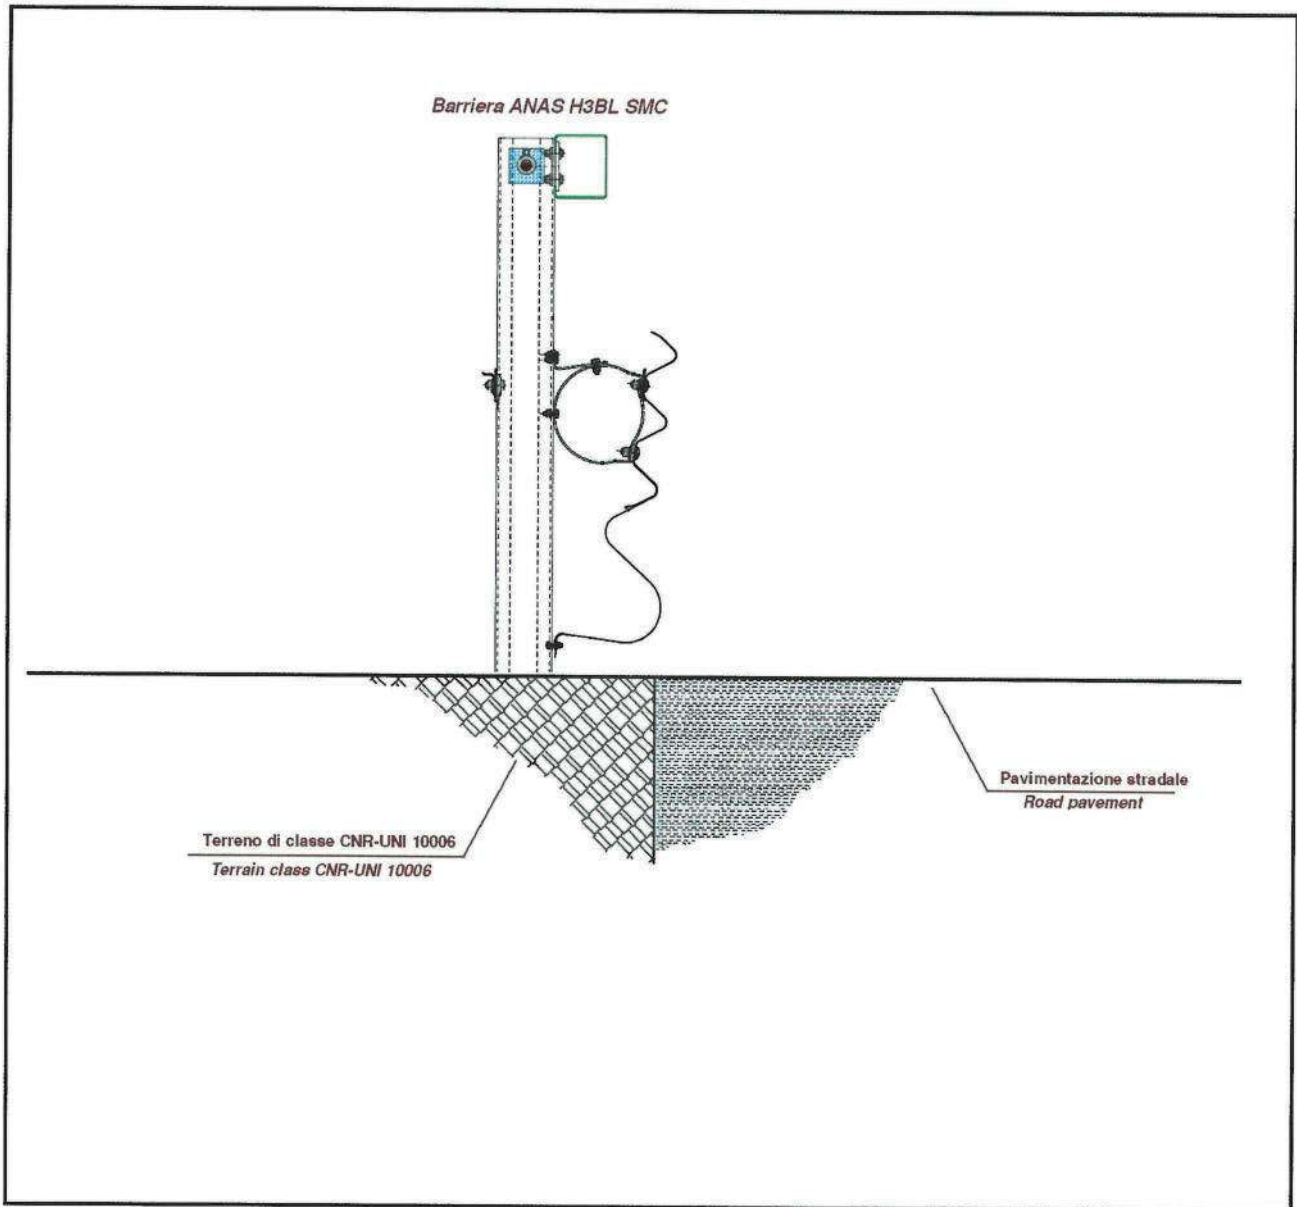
Figure 2 Sezione dell'installazione – The installation section
